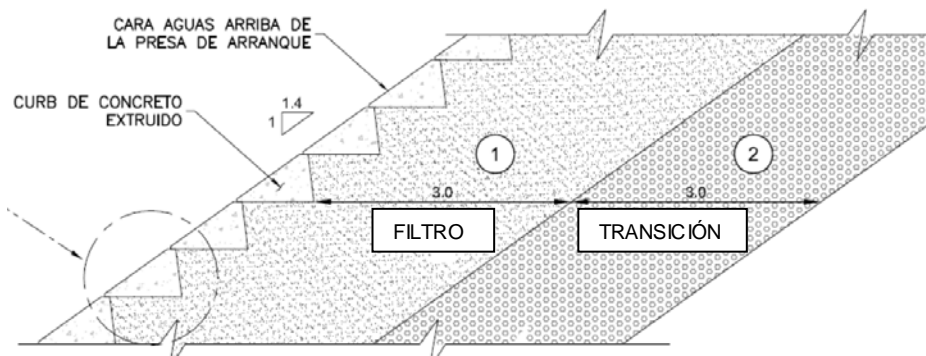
Curb de concreto extruido típico para presas tipo CFRD
